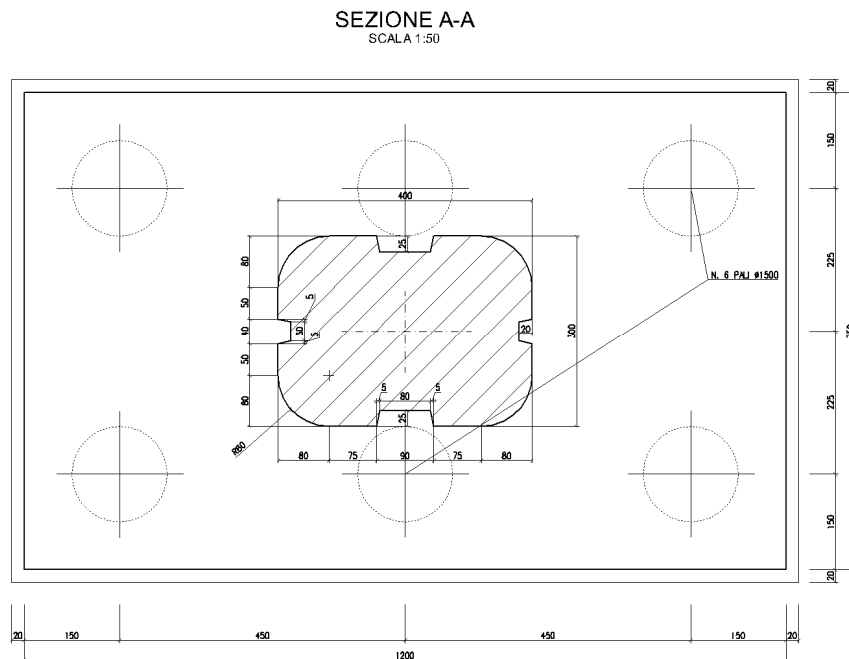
Pianta del plinto di fondazione tipo C.
